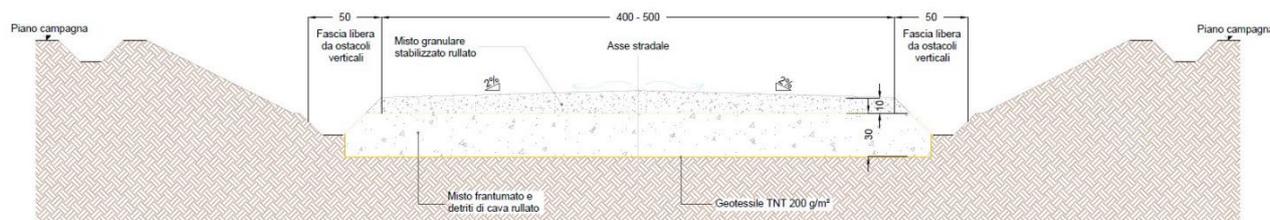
Sezione tipo pista di impianto a in trincea; misure in centimetri
